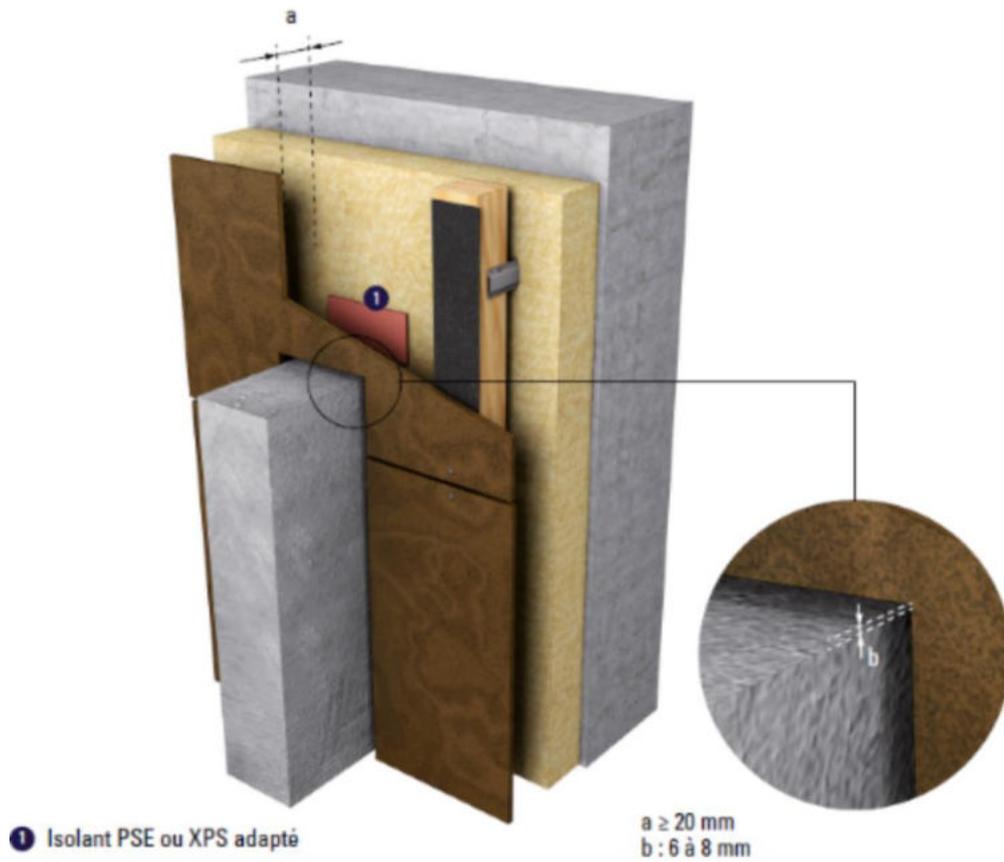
Jonction horizontale refend épaisseur 25 cm maxi – coupe verticale
